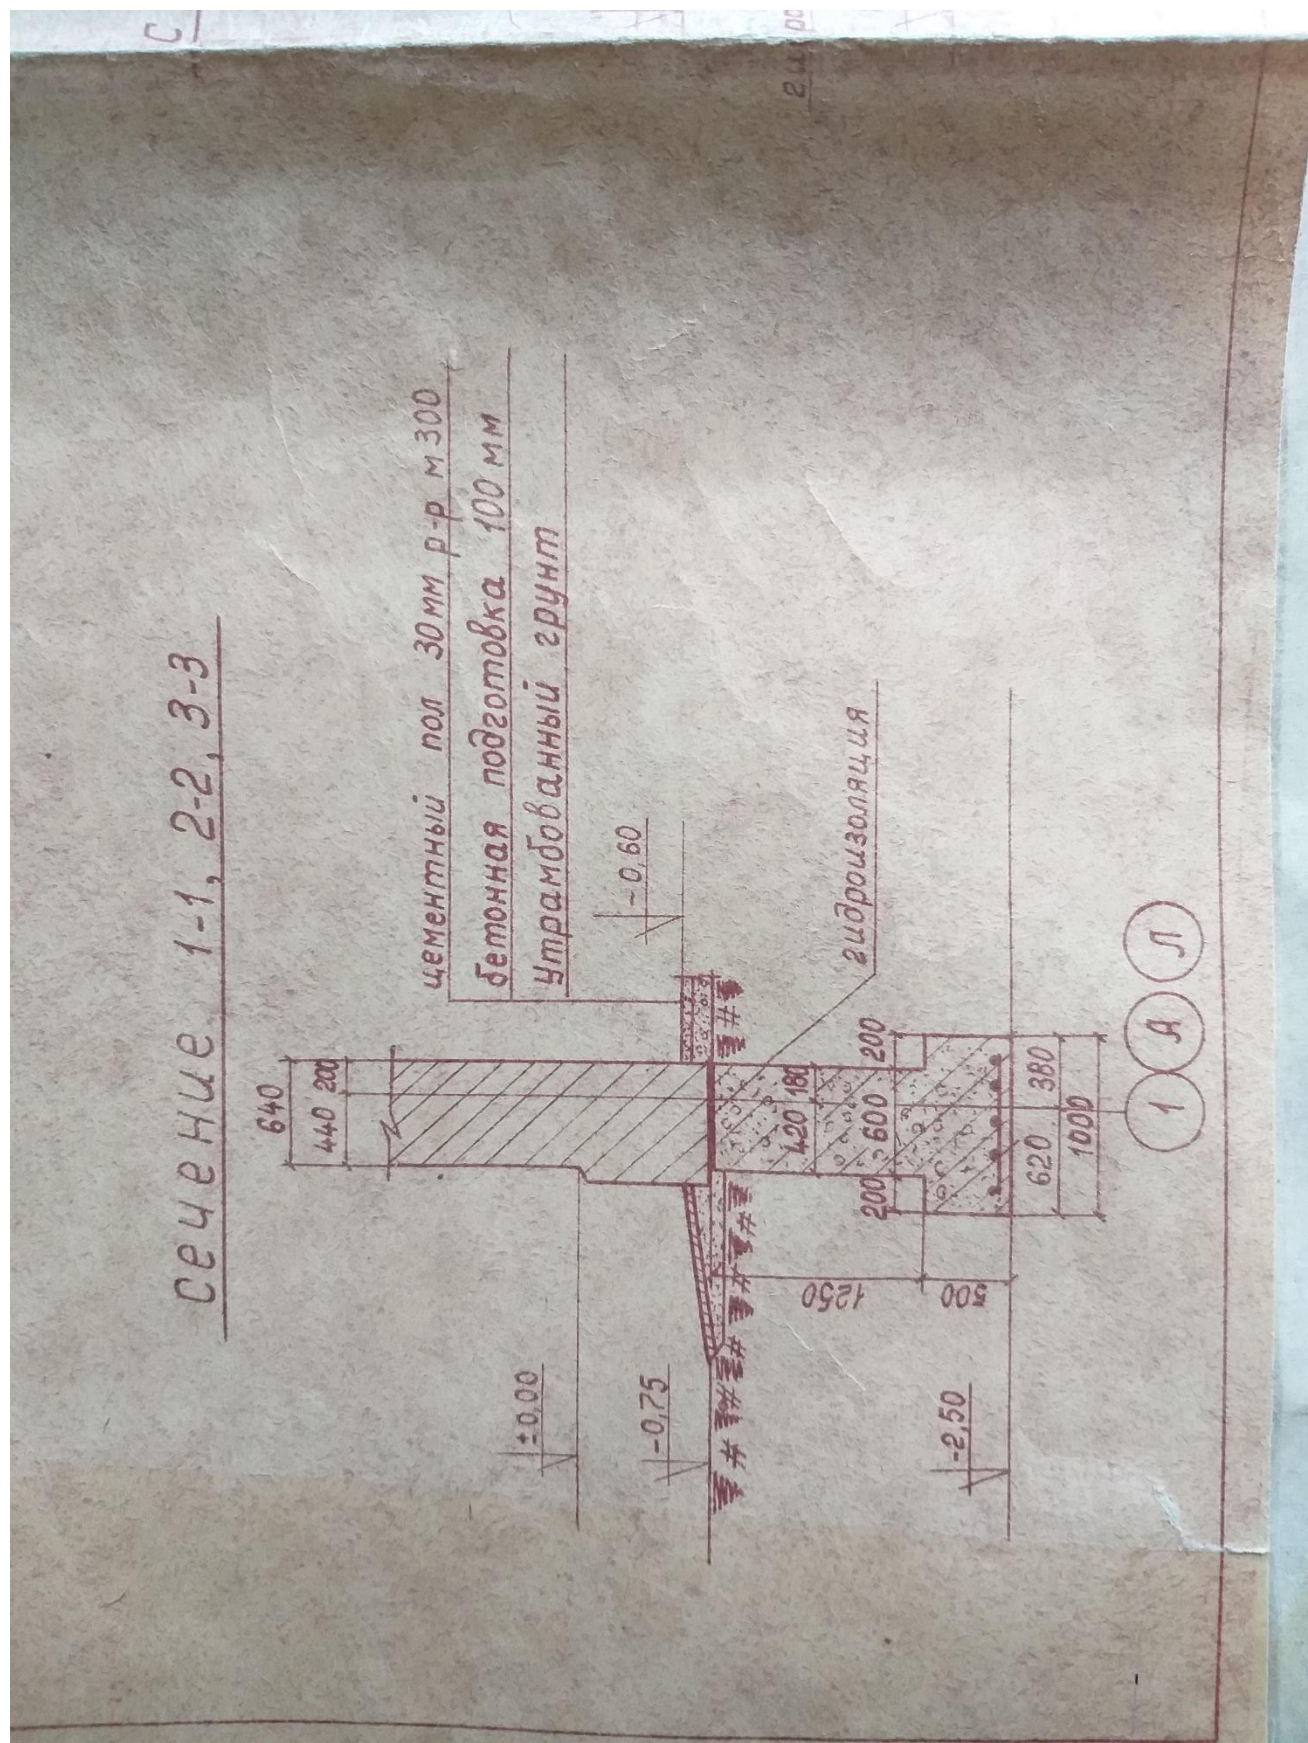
Сечения 1-1, 2-2, 3-3 (к плану фундамента)
